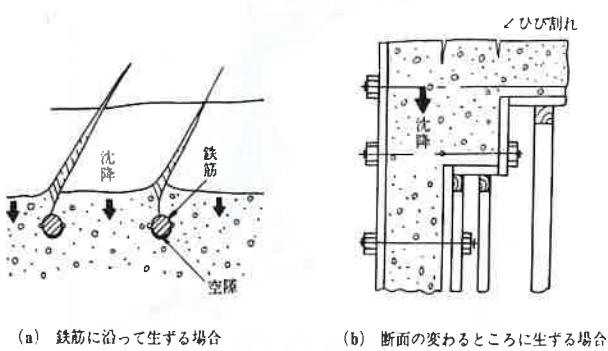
沈みひび割れの施工時の抑制対策<sup>7)</sup>
